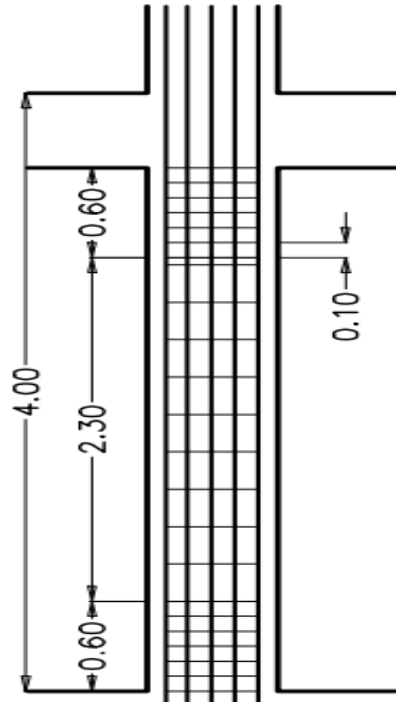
Distribución de acero longitudinal Columna 55 x 55cm
